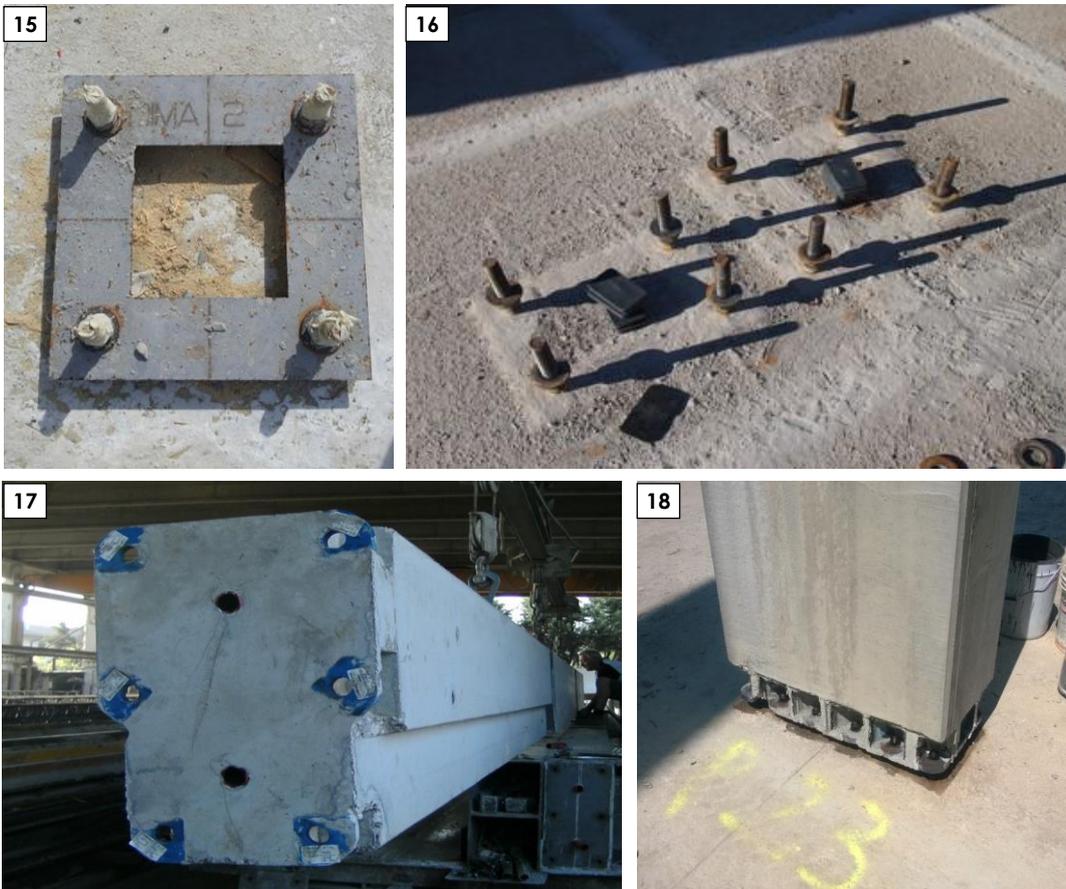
, 16, 17,18 – Connessione alla fondazione con "scarpa"
